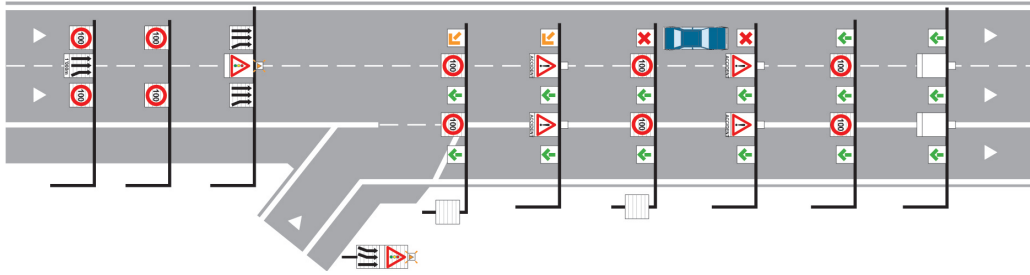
33.1+76.1 BAU fermée : événement sur la voie de dépassement avec R-BAU.
